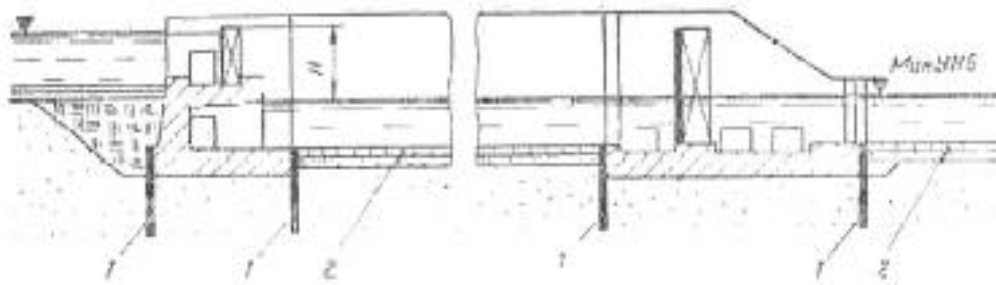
Поздовжній розріз шлюзу з водопроникним днищем:
